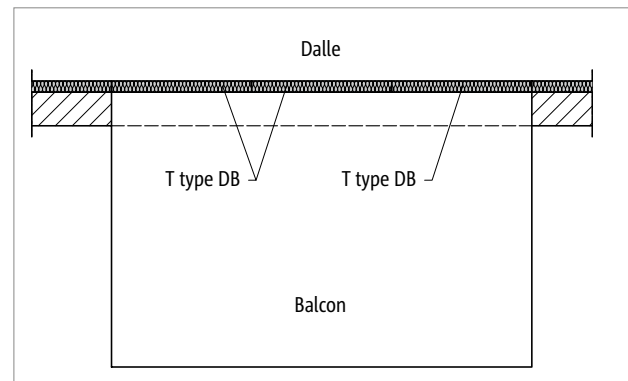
Schöck Rutherma® T type DB : balcon en porte-à-faux et plancher constitué de prédalles
